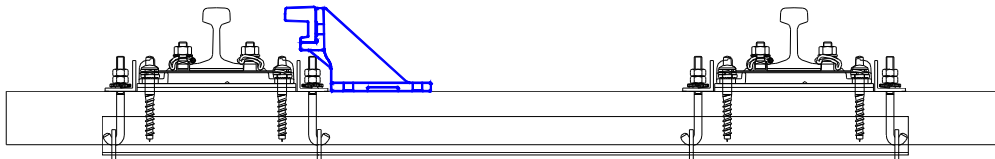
Contra-carril (suporte e perfil U-69).
